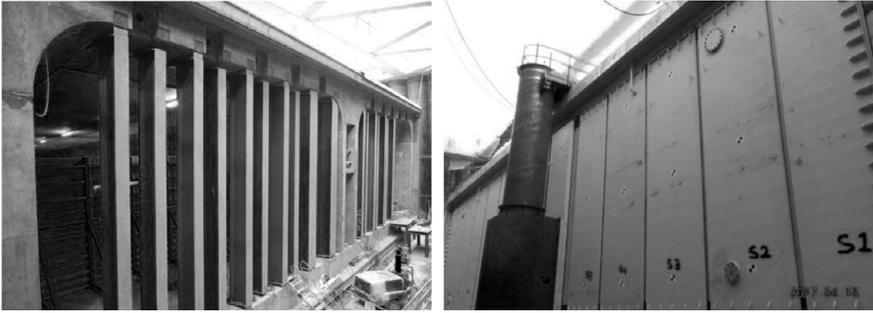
Abschottung Tunnelement mit Zugangsschacht
